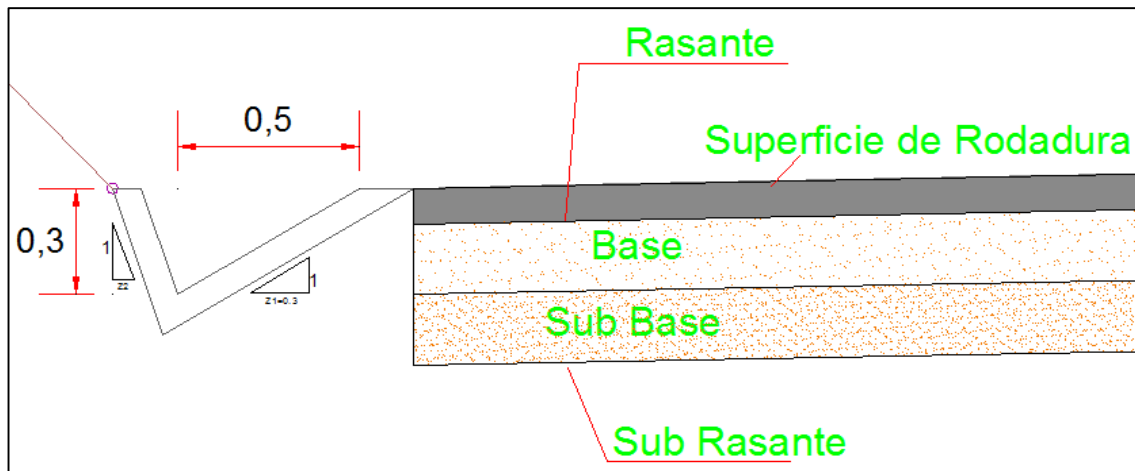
Cuneta Propuesta para el Drenaje Longitudinal
